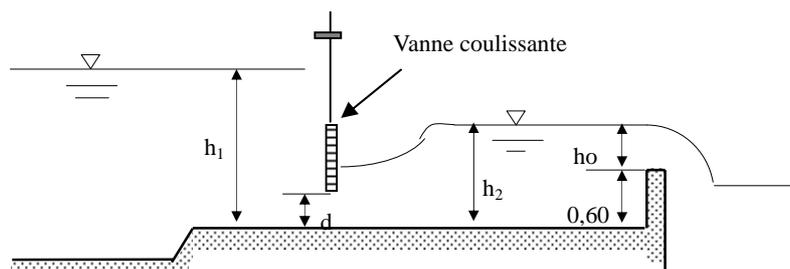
Plan longitudinal du partiteur de type vanne
